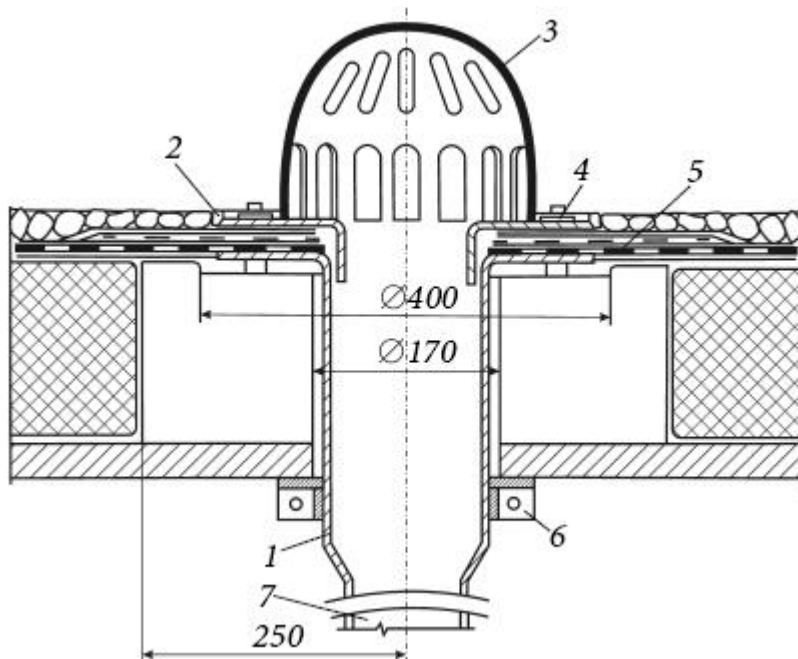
Устройство водосборной воронки на плоской кровле (размеры в мм): 1 – сливной патрубков (сама воронка); 2 – прижимной фланец (кольцо или рама); 3 – защитная крышка; 4 – стяжной болт; 5 – гидроизоляционный ковер; 6 – хомуты; 7 – водосточный стояк
